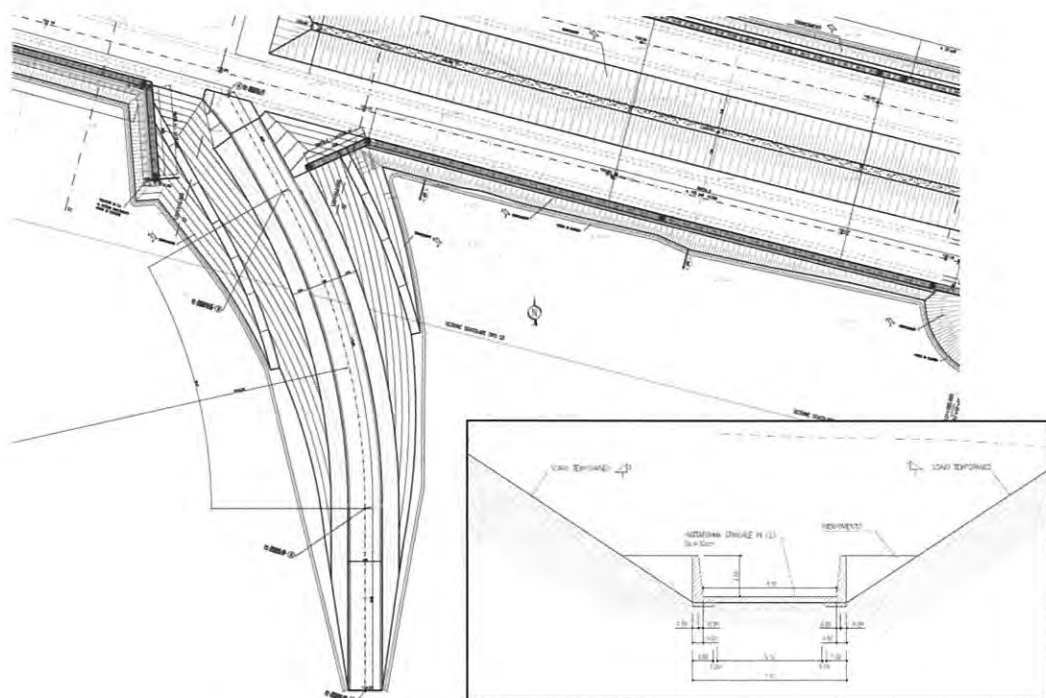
Planimetria della rampa di accesso e sezione tipologica muri ad U
